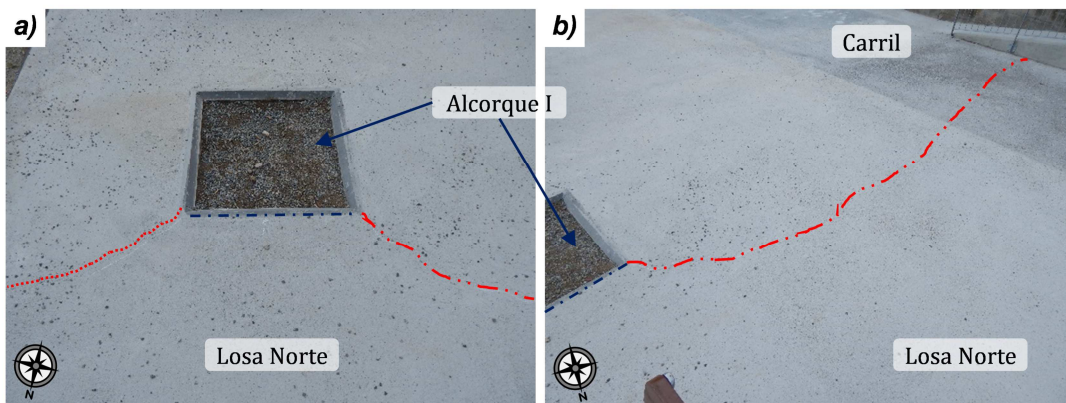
72 – Fisura a  $45^\circ$  en alcorque de losa Norte (parte inferior)
